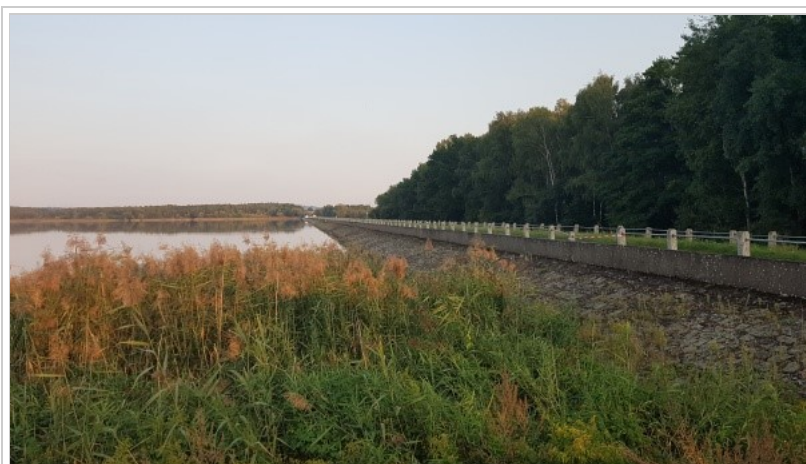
Zbiornik Kozłowa Góra – widok z zachodniego przyczółka zapory (fot. M. Rzętała).
